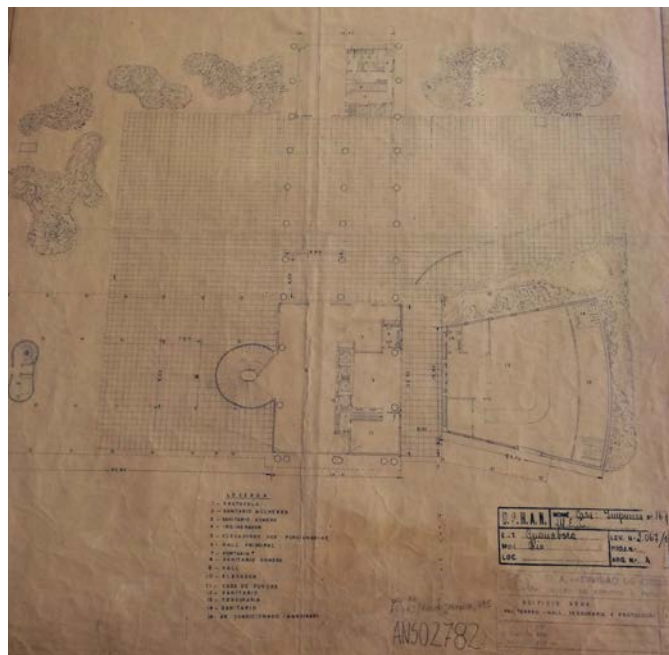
Foto documentação Projeto as-built, 1947- Pavimento. Térreo
